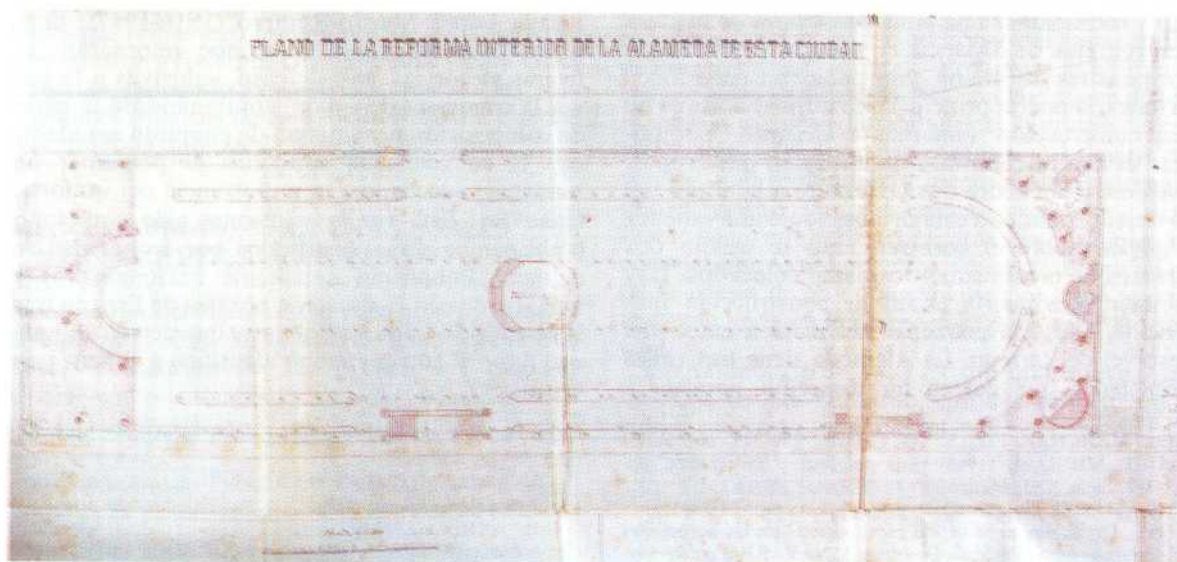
La Alameda, planta Laureano Arroyo, 1890
